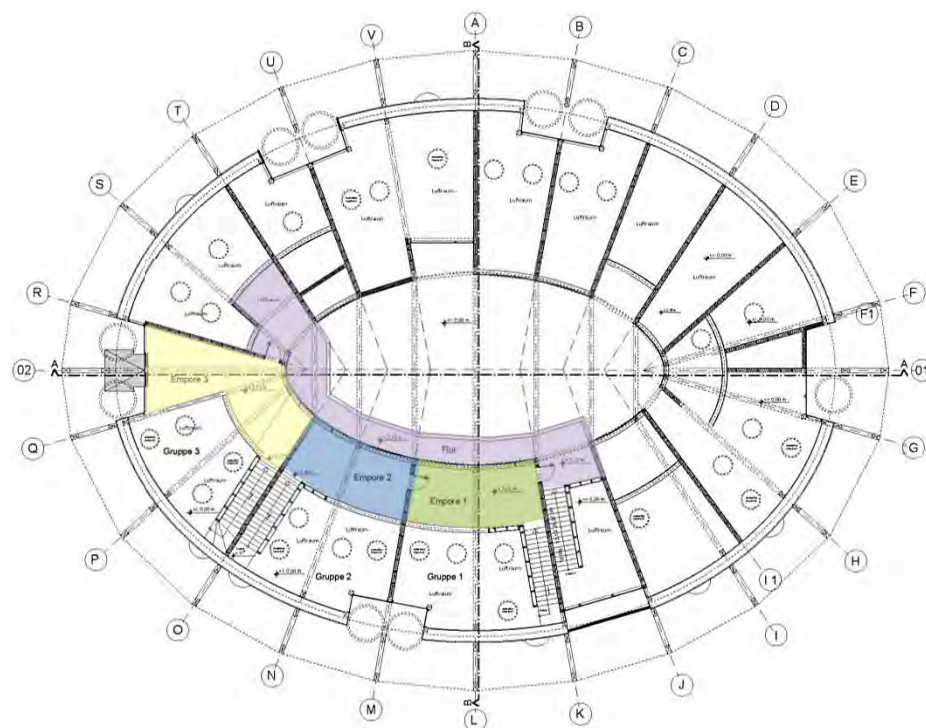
Grundriss Obergeschoss – Kindertagesstätte „Wildblume“
